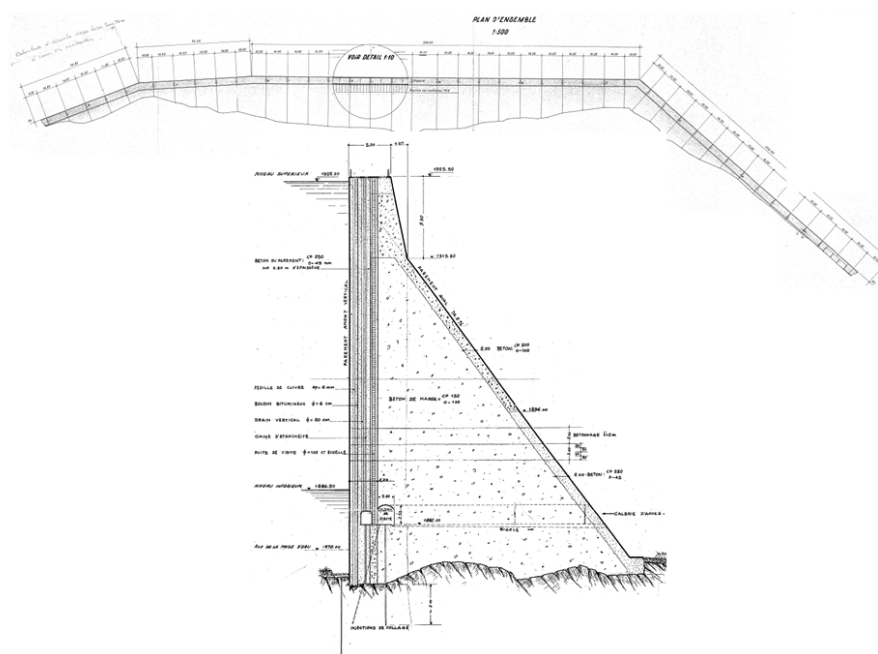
Vue en plan générale et coupe verticale type du barrage de Salanfe.
